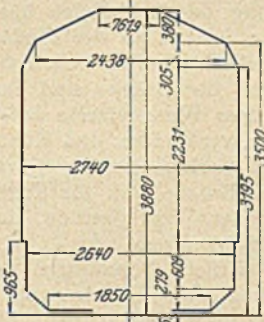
Japanische Staatsbahn, Spurweite 1067 mm.
